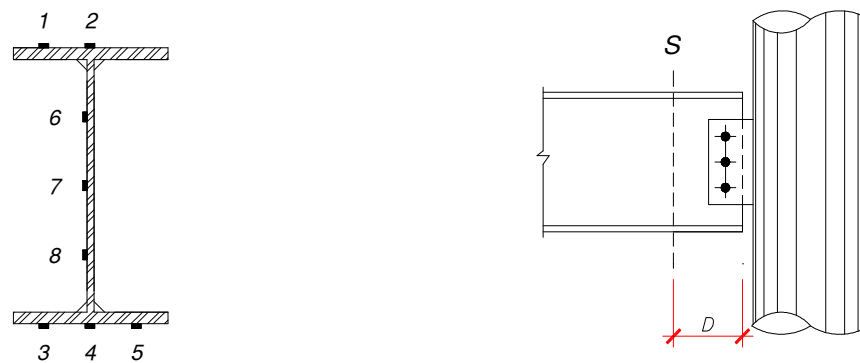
Disposição dos extensômetros na alma e na mesa da viga.
